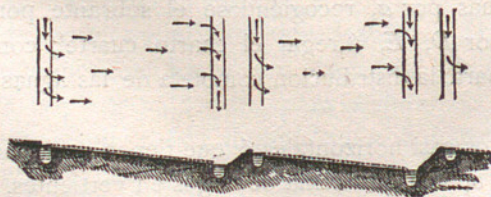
Disposicion de un terreno llano en planchas ó tablas inclinadas.
